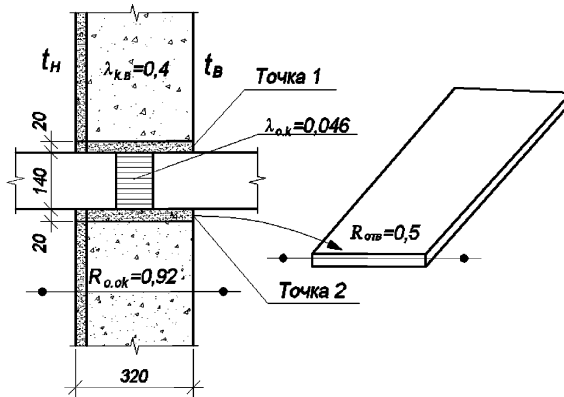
Стык однослойных панелей с консольным защемлением плит перекрытий
